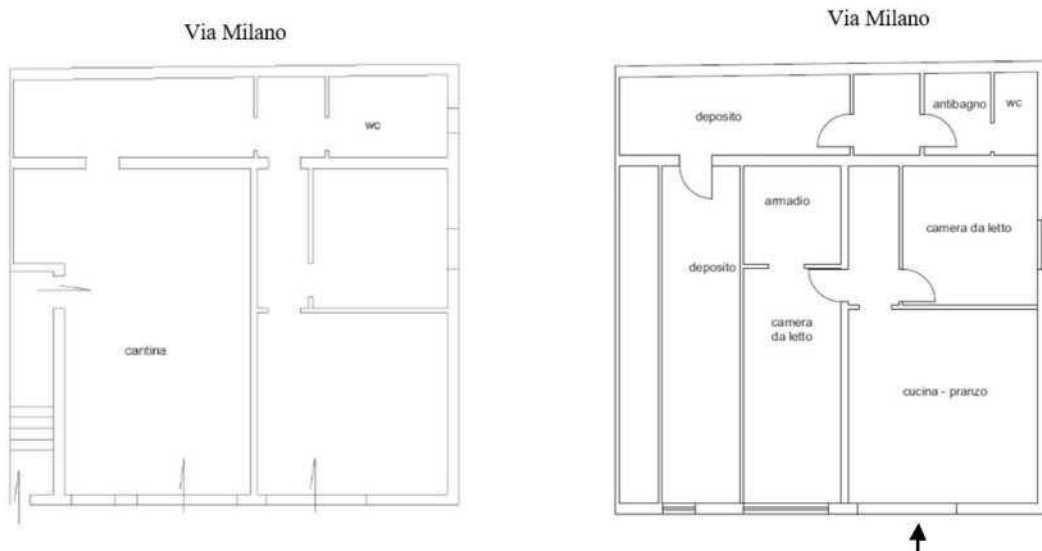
Planimetria catastale del magazzino posto al piano terra sub 3 e rilievo stato di fatto.
